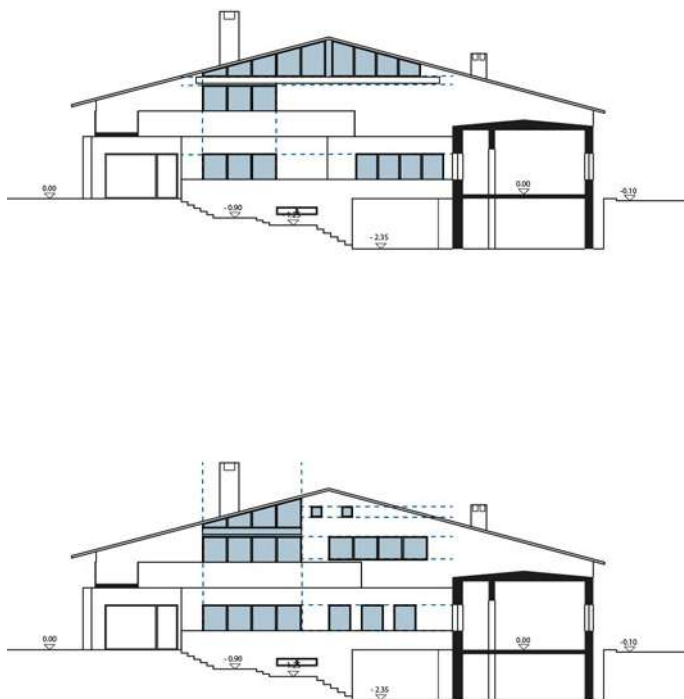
Prospetto sud, confronto tra prospetto di progetto e prospetto realizzato
